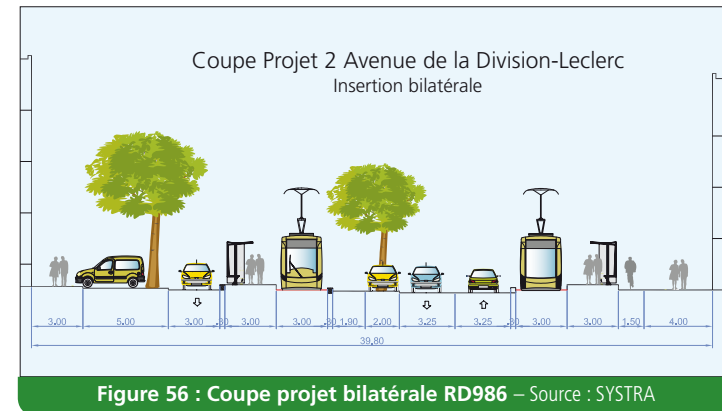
Coupe projet bilatérale RD986 – Source : SYSTRA
